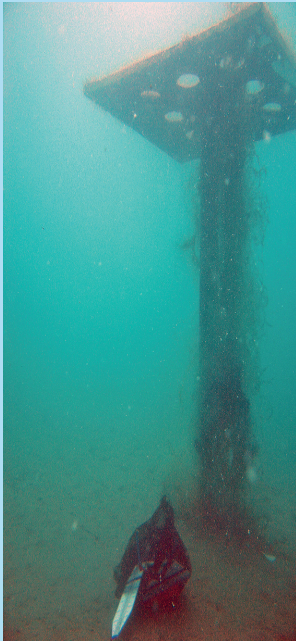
L'un des points de contrôle en mer installés sur la plage submergée au nord de l'embouchure du F. Arno. Le poteau doit être fixé au fond à l'aide d'un carottier à vibrations et la plaque doit avoir des trous pour réduire les forces de traction ascendantes et descendantes qui se produisent lors du passage des vagues. De plus, sa partie supérieure doit être nettoyée périodiquement, car les incrustations et les algues qui risquent de s'y développer peuvent augmenter sa hauteur. Il s'agit donc d'appareils à installer dans les cas où une grande rigueur des mesures bathymétriques est exigée.
